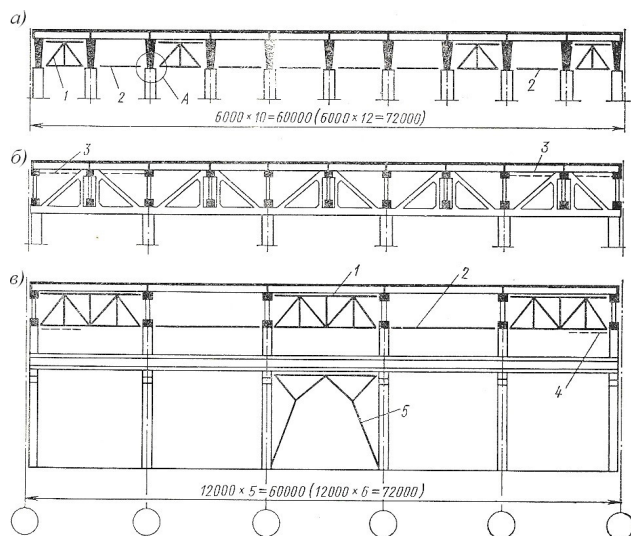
Расположение связей жесткости железобетонного каркаса здания:
